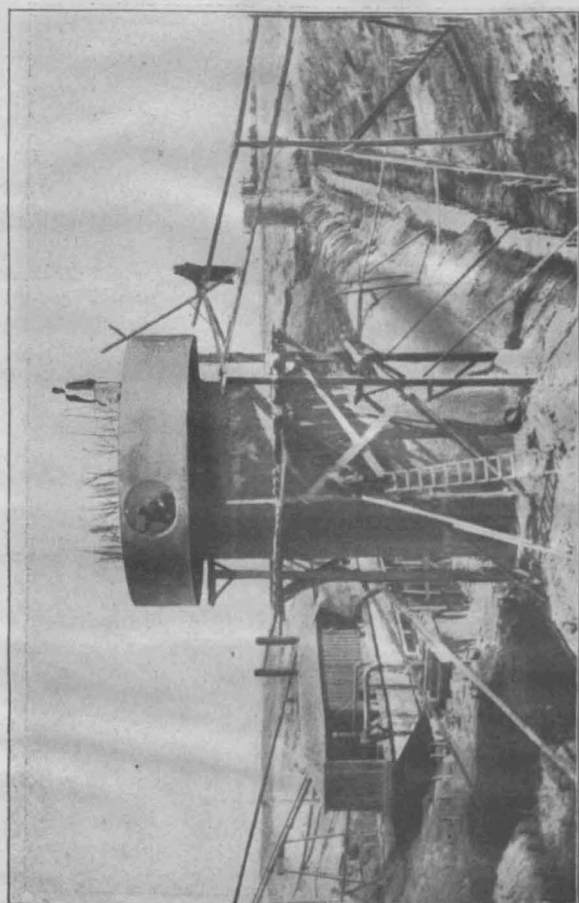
Eisenbeton-Dücker in Ausführung. Südlicher Schacht.
